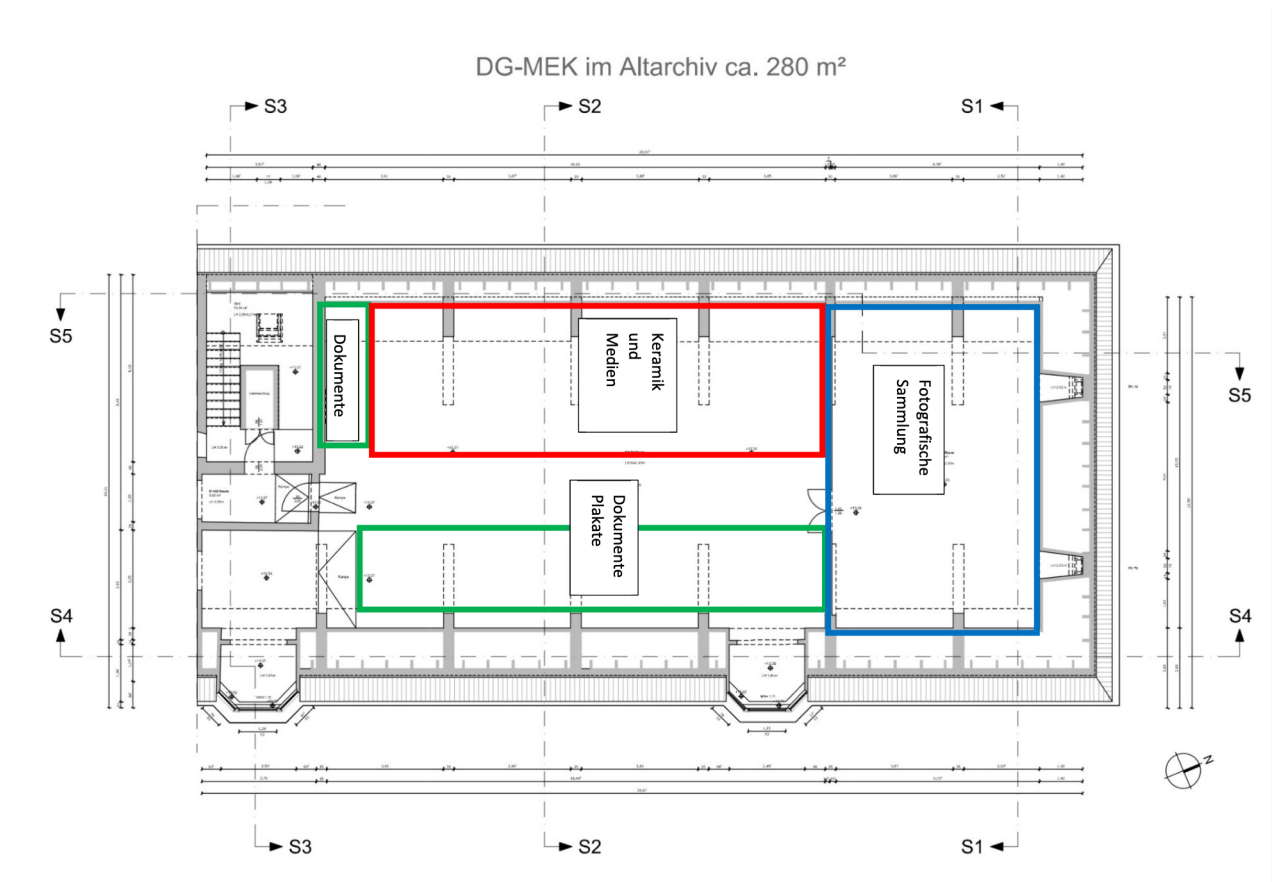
Grundriss und Aufteilung Raum 312c. ©SPK
